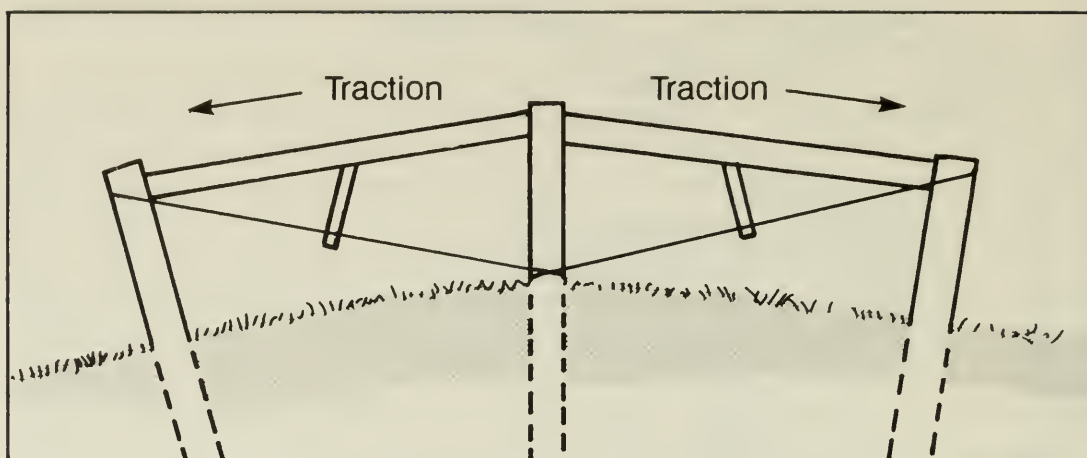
Assemblage d'ancrage à double empattement pour poteaux de butte.
